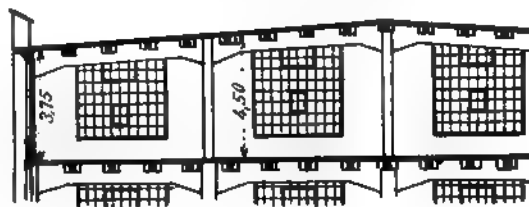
Dachquerschnitt der Singer-Fabrik in Wittenberge.
